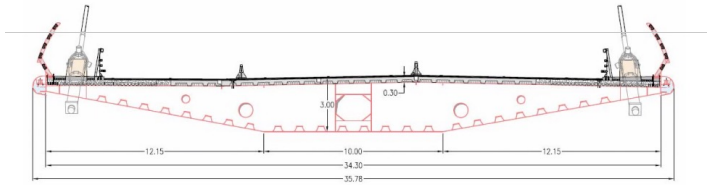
Sección transversal del tramo atirantado. Puente de la Constitución de 1812.
